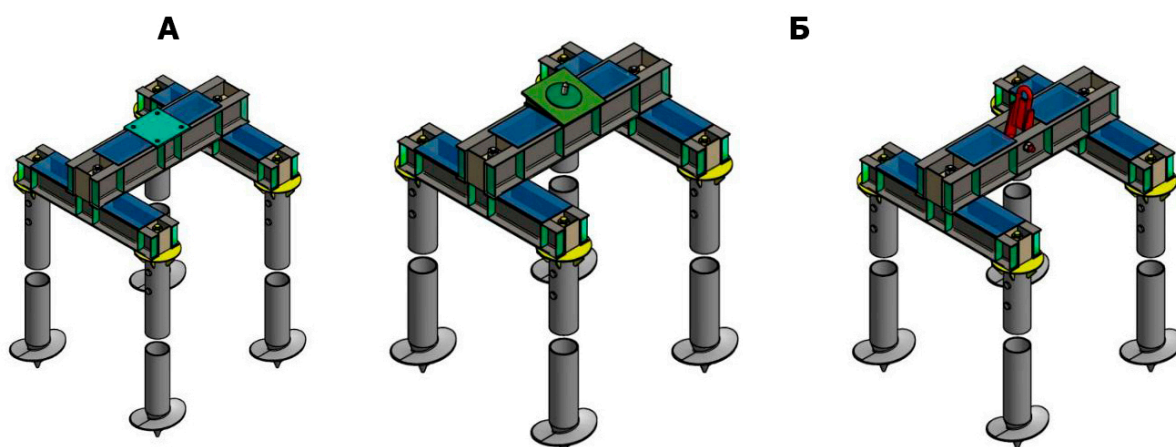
Конструкция фундаментов для ВЛ 750 кВ «Белозерская» - «Ленинградская» а) – под башенные опоры б) – под опоры на оттяжках
